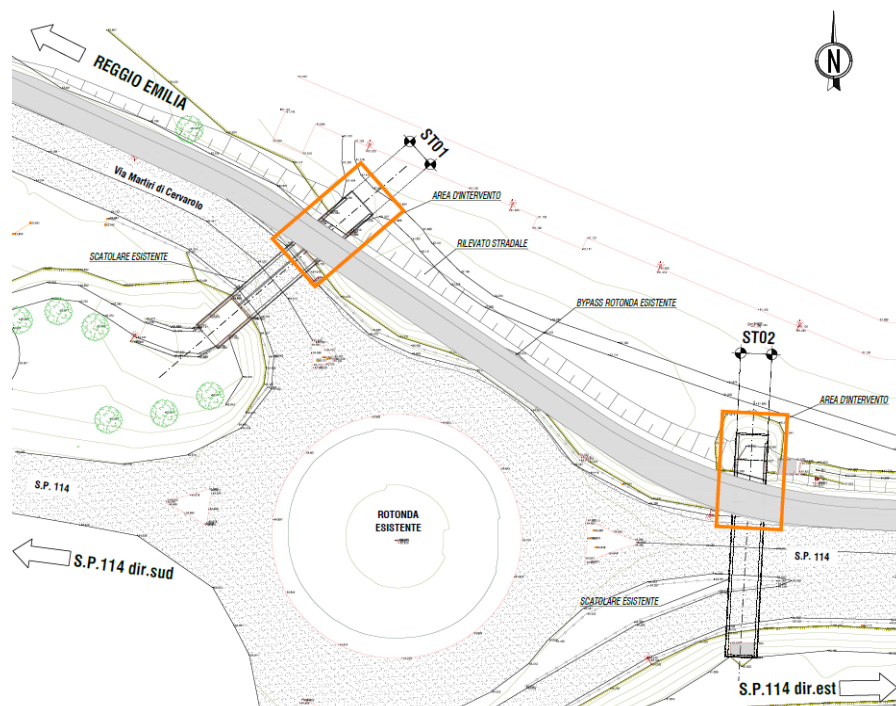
Planimetria generale opere ST01 e ST02.
